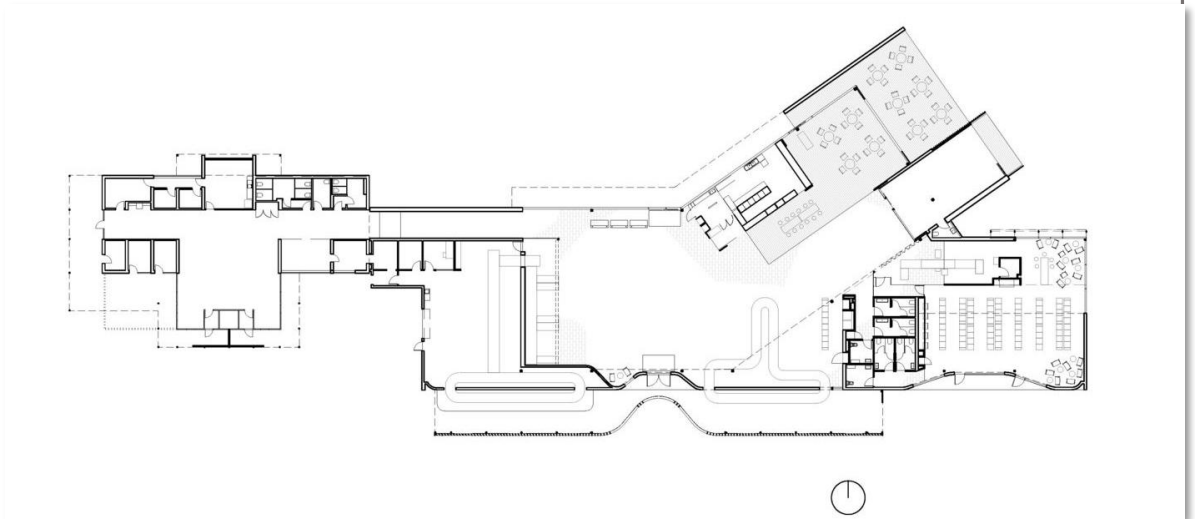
Terminal Aérea de la Isla Canguro, Australia – Plano de planta. Fuente: https://www.archdaily.com/911713/kangaroo-island-air-terminal-ashley-halliday?ad_medium=gallery
